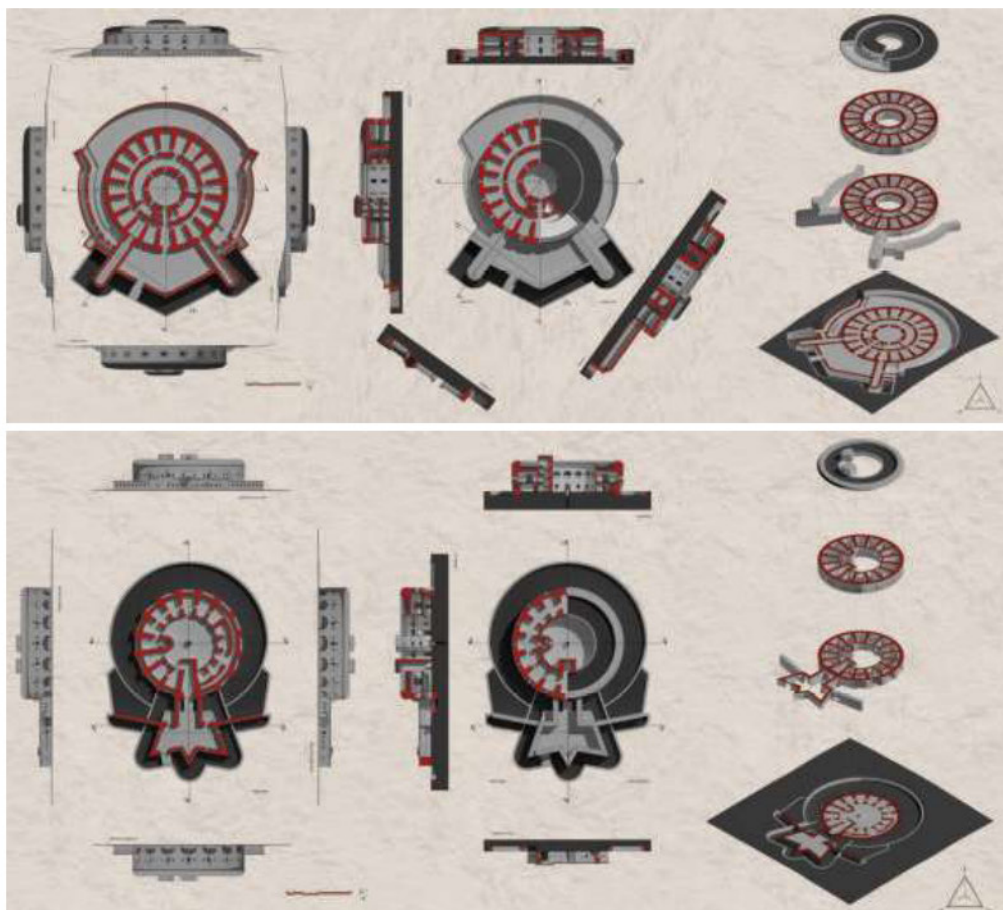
a) Fort Bourguignon b) Fort San Giorgio: piante piano terra e prospetti; piante piano primo, copertura e sezioni; esploso assometrico (elaborazione grafica di Petar Bašić)
